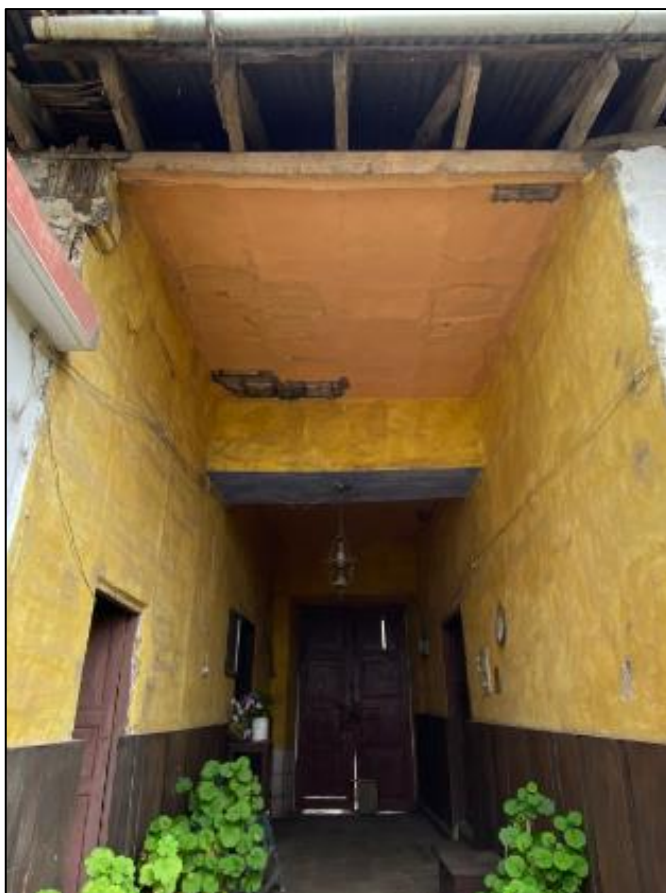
Fachada de la casa 1. Fuente: Elaboración Propia
